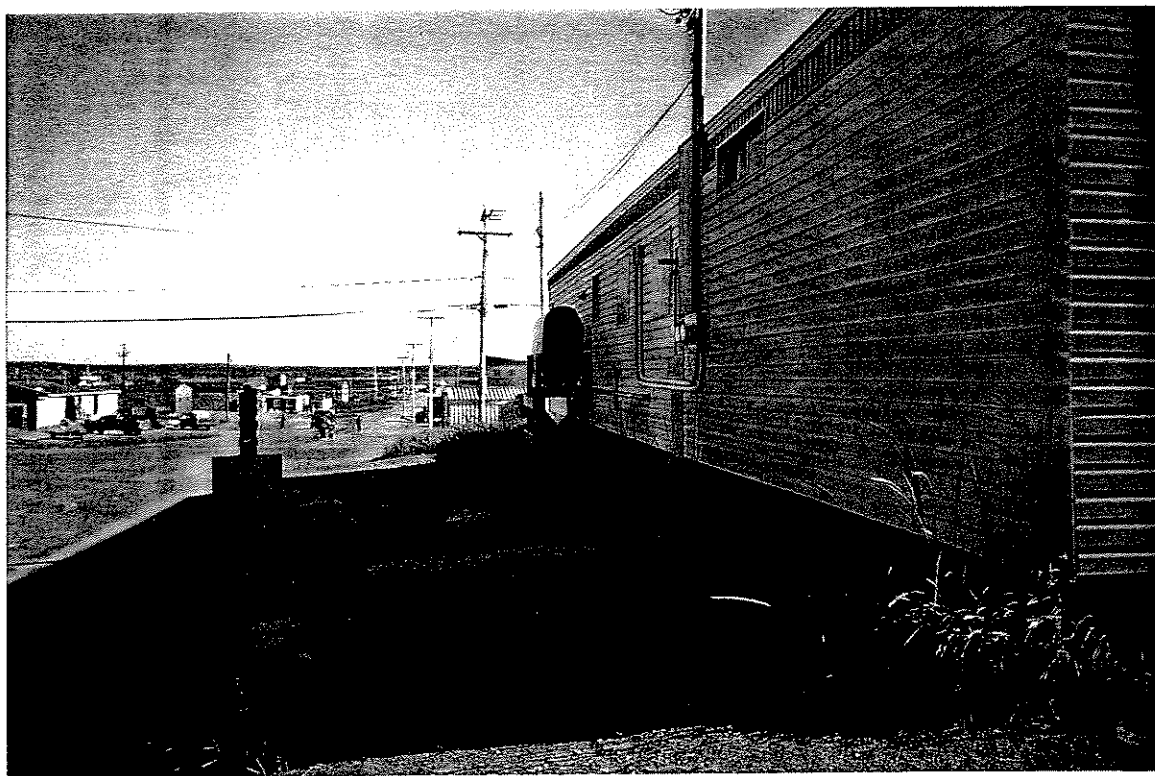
Réservoir de mazout 1 136 litres sur le côté du bâtiment de Nayumivik Landholding Corporation.
